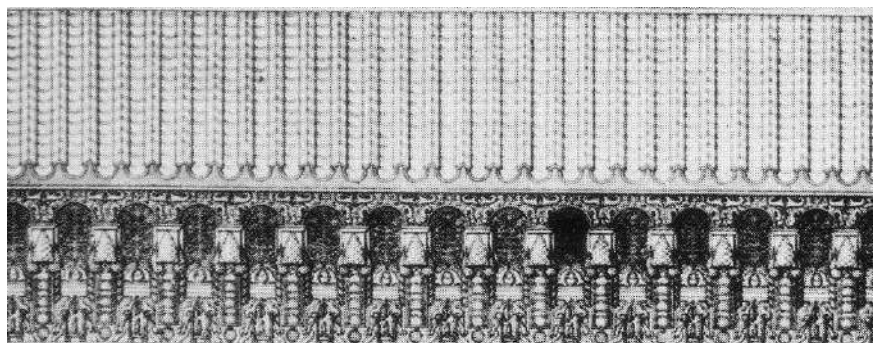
Fachada de Comares, alzado restituído según Owen Jones (1842) y detalle del remate del faldón, siguiendo el diseño de la pieza existente en esta fachada. (*Planos, alzados, secciones y detalles de la Alhambra*).
